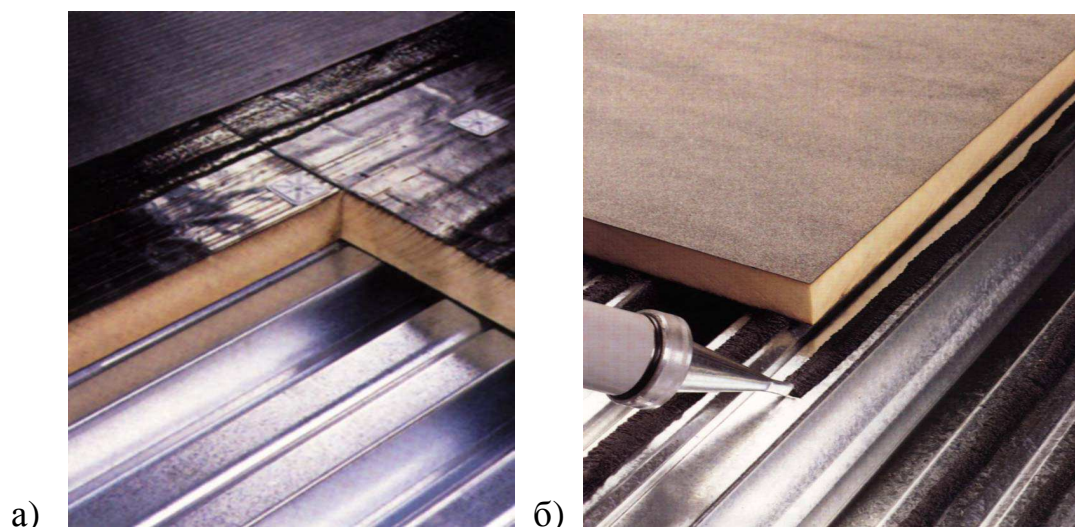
Укладка жёстких теплоизоляционных плит на основу из профлиста:
